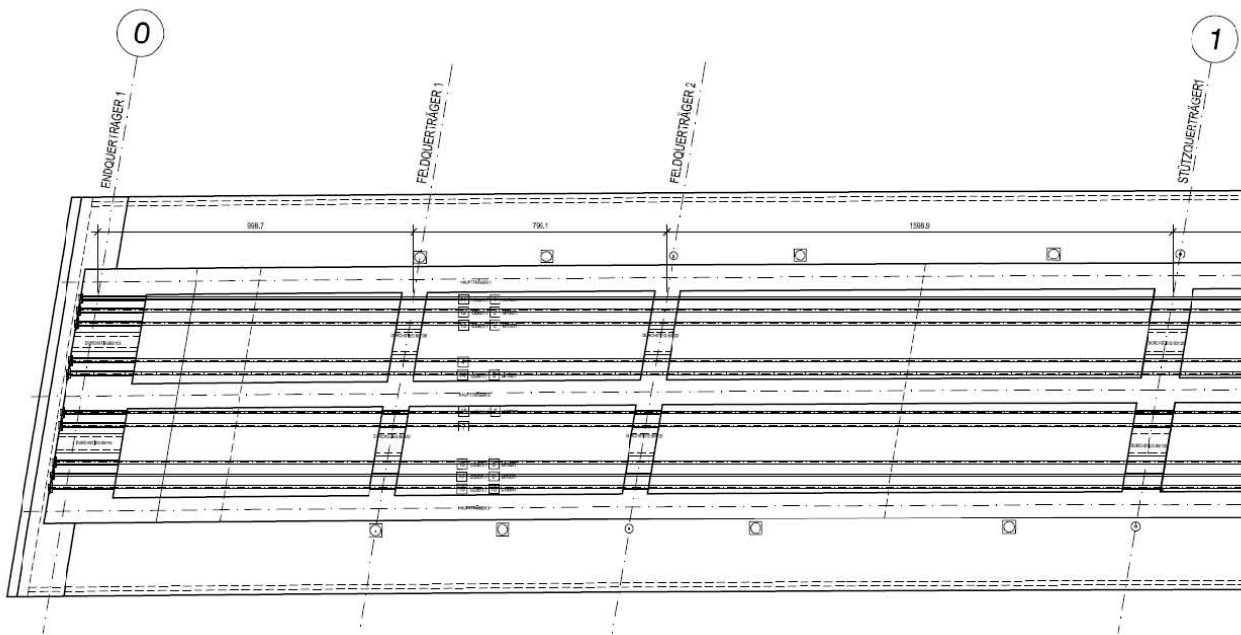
Grundriss des Teilabschnittes vom Widerlager Achse 0 bis zur Achse 1
